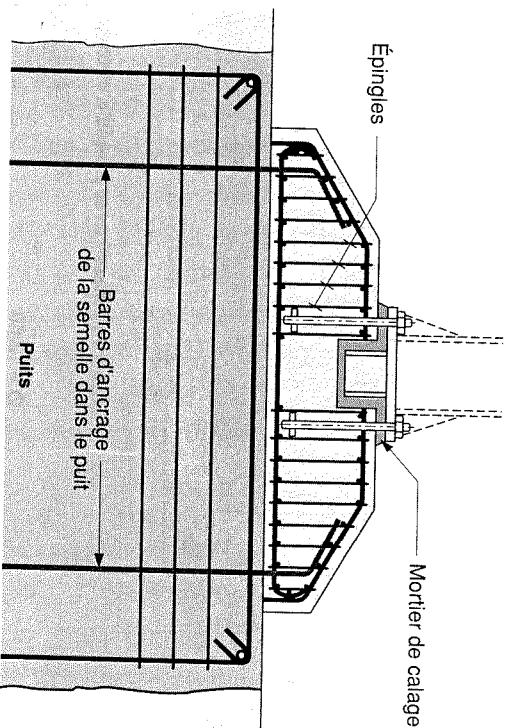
Ancrage dans une semelle disposée sur un puits.
